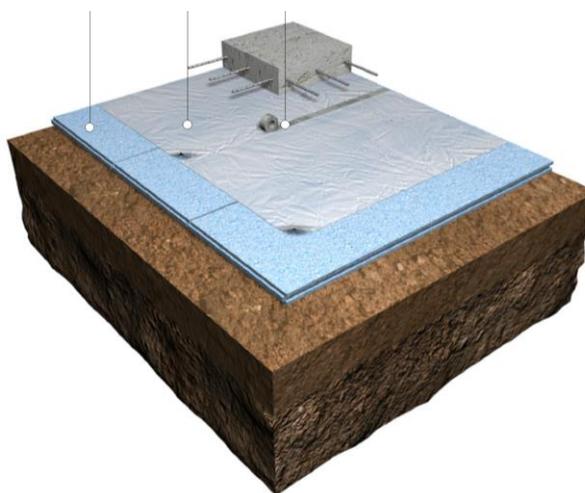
Impermeabilización y aislamiento térmico de solera de hormigón
